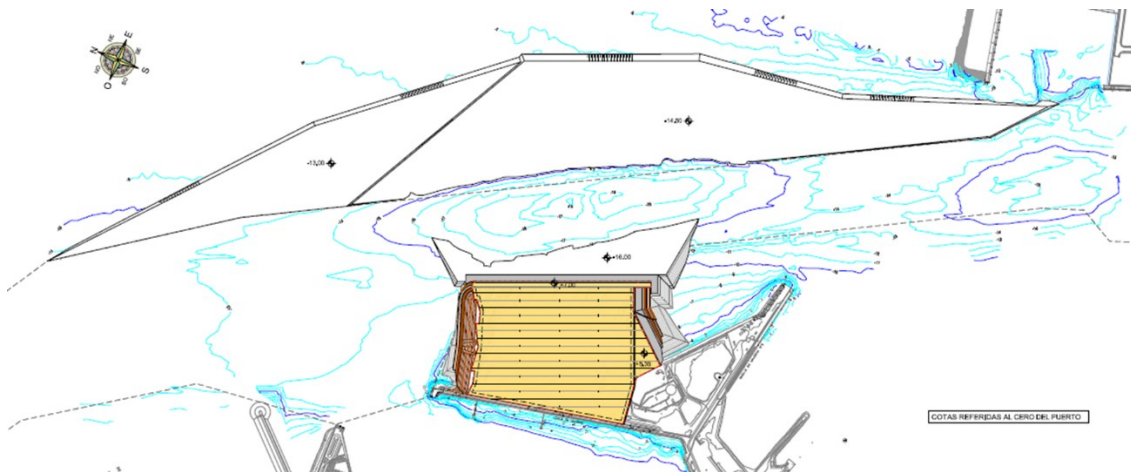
Planta general de la primera fase de la NTC, perteneciente al proyecto constructivo. Fuente: APBC
